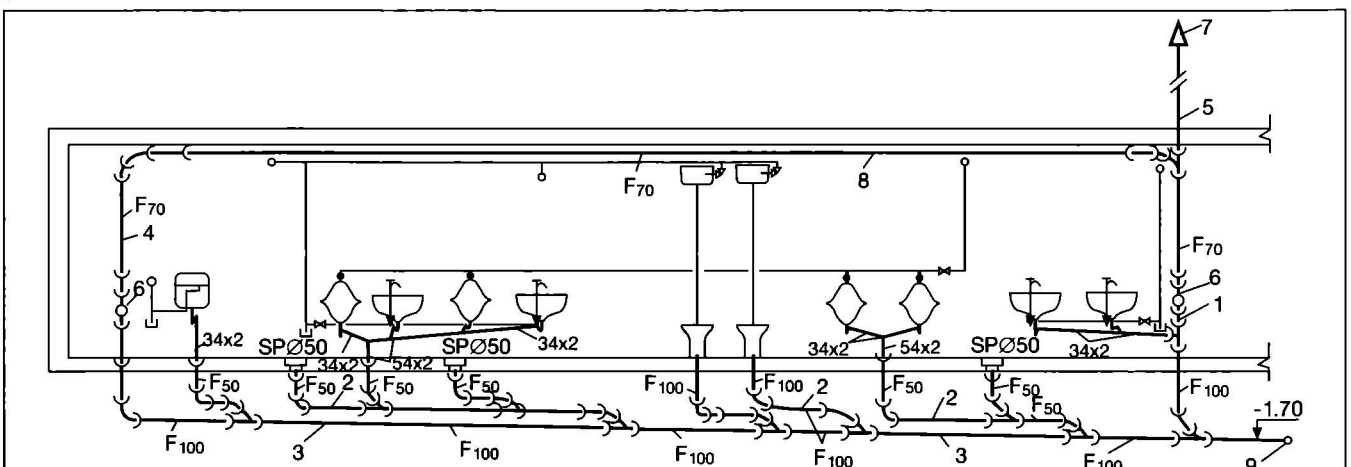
Ventilarea secundară a instalației de canalizare:
